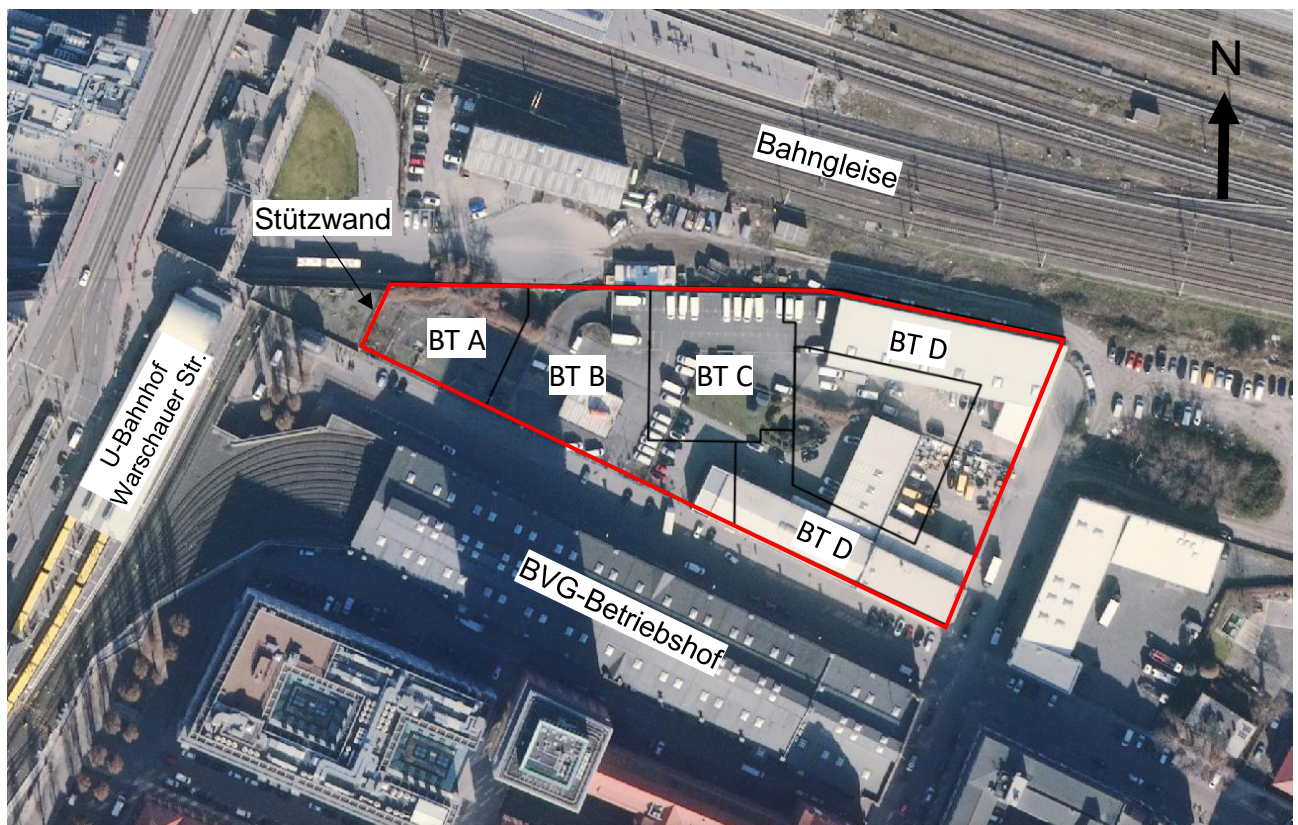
Lage des Baugrundstücks mit den geplanten Bauteilen A bis D (rot) und den Nachbarbauwerken [Luftbild: Geoportal Berlin]
